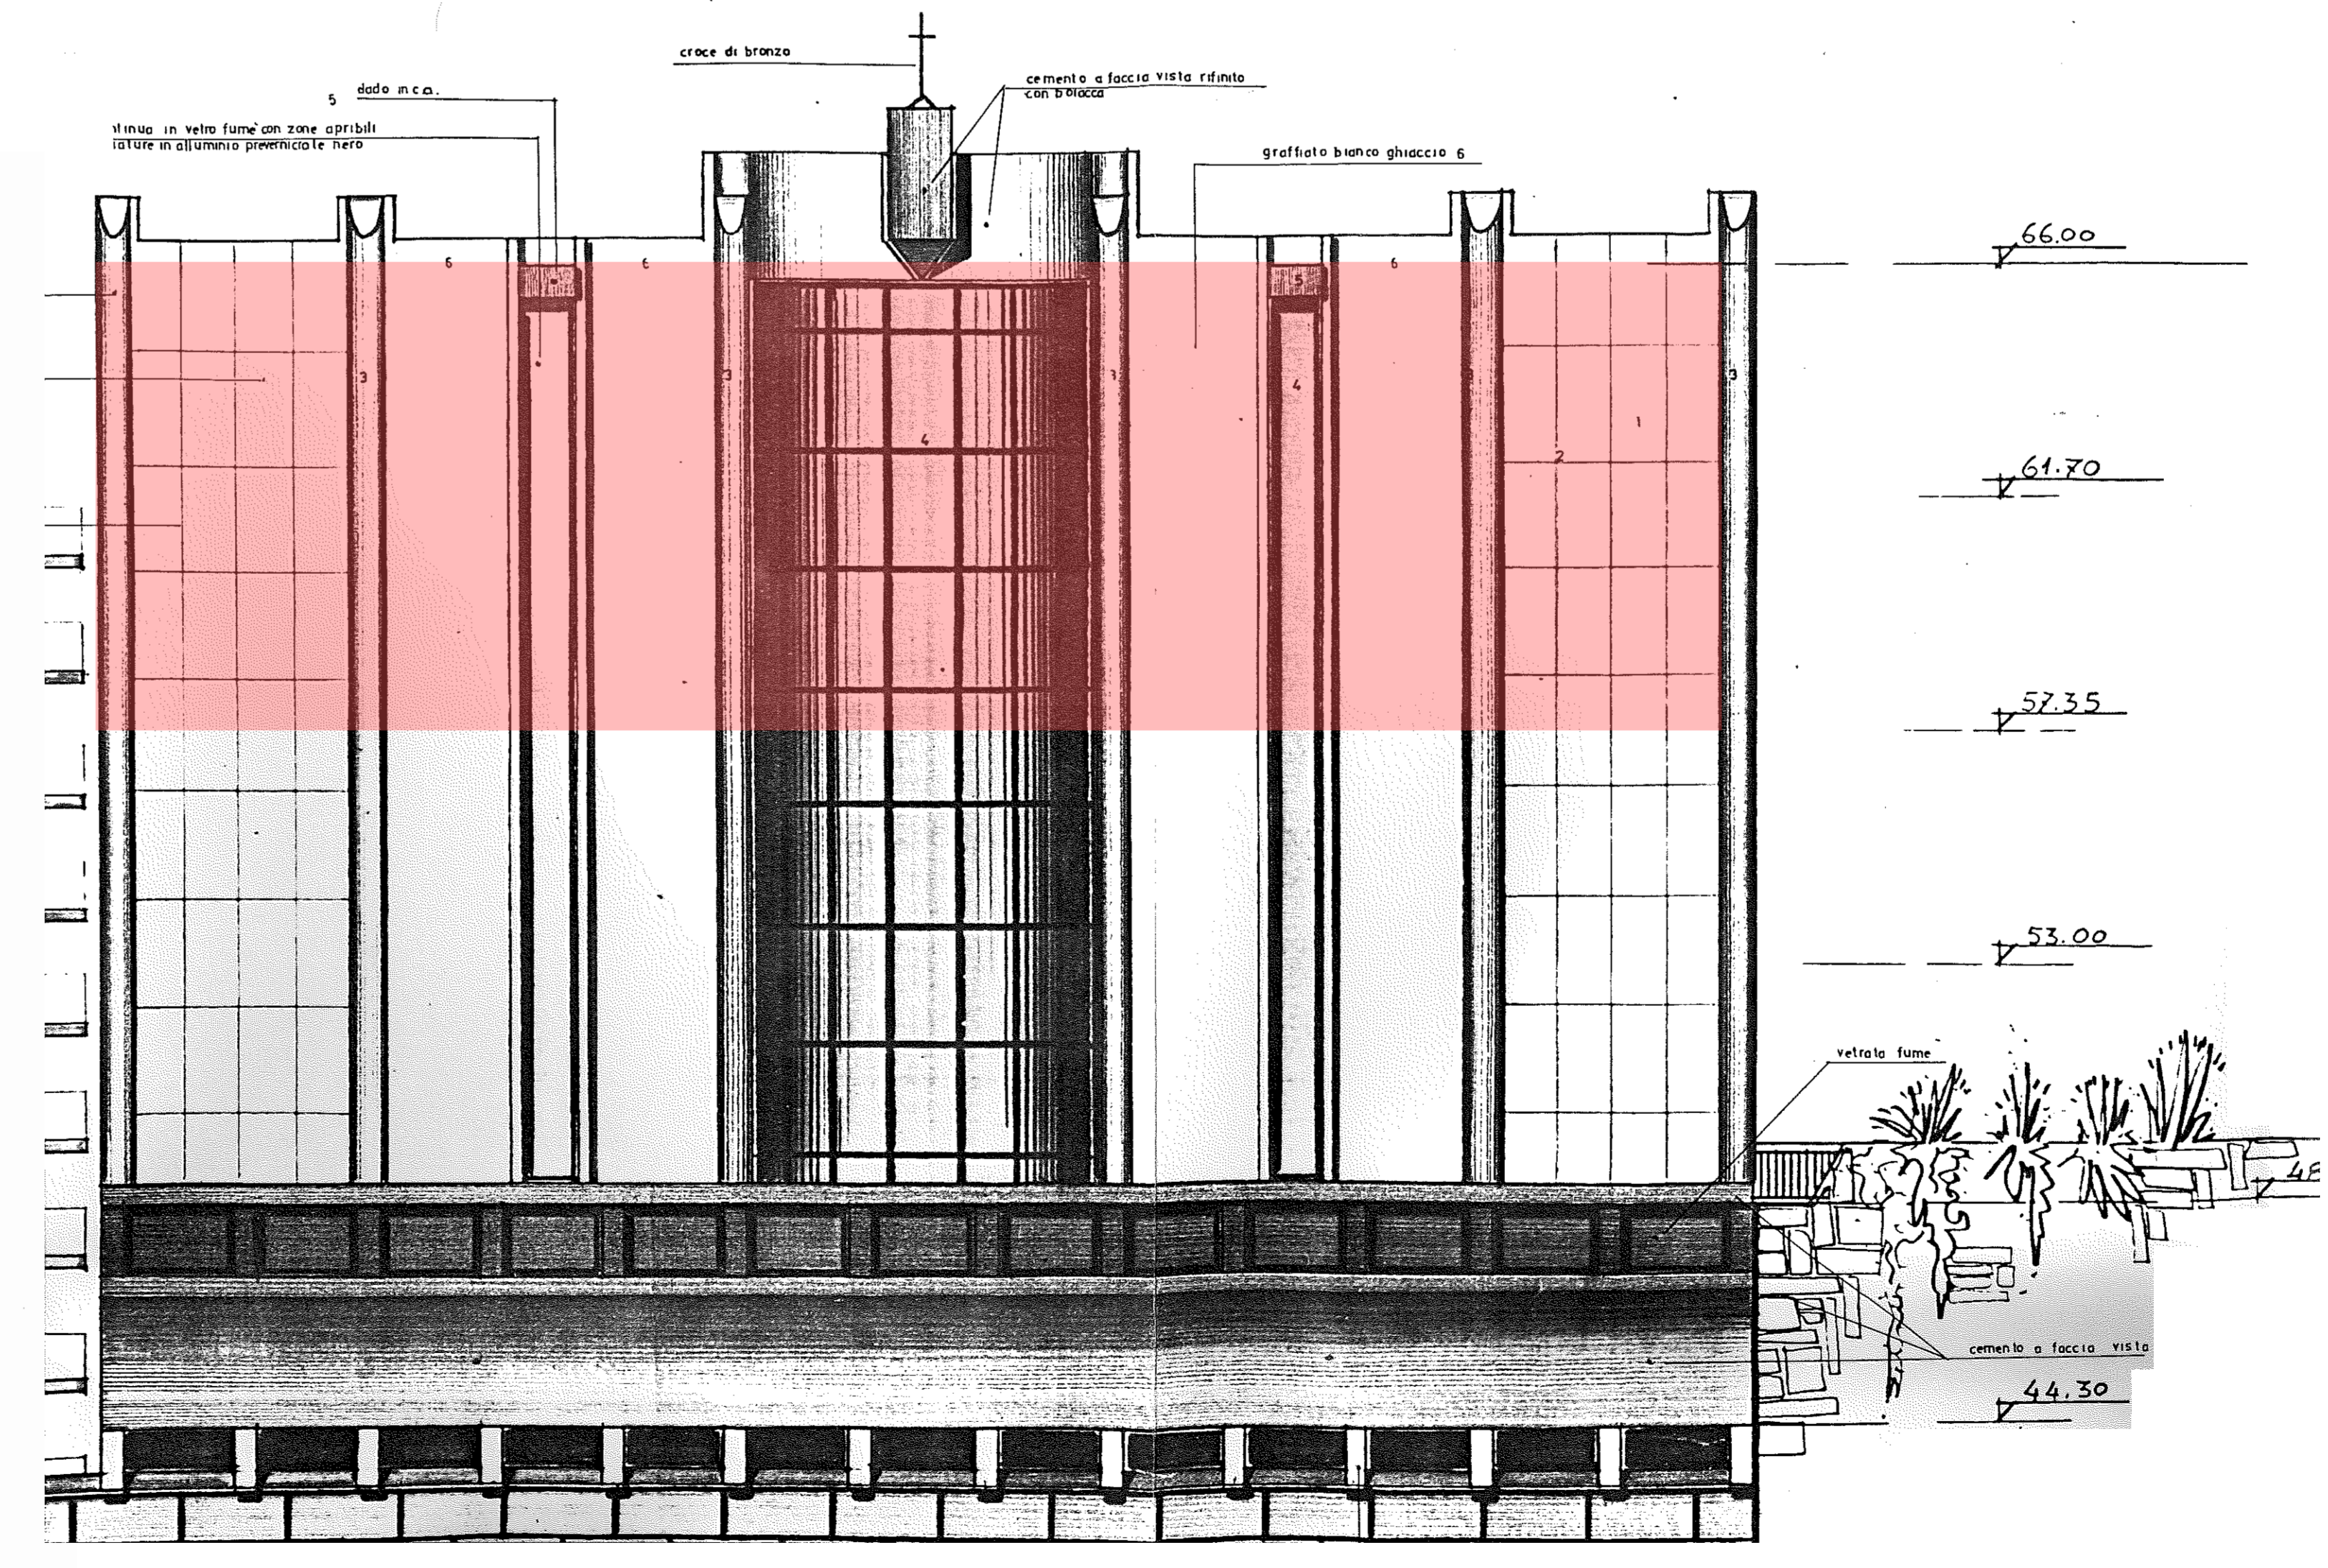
\_Vista frontale dal basso con indicazione della porzione da demolire
